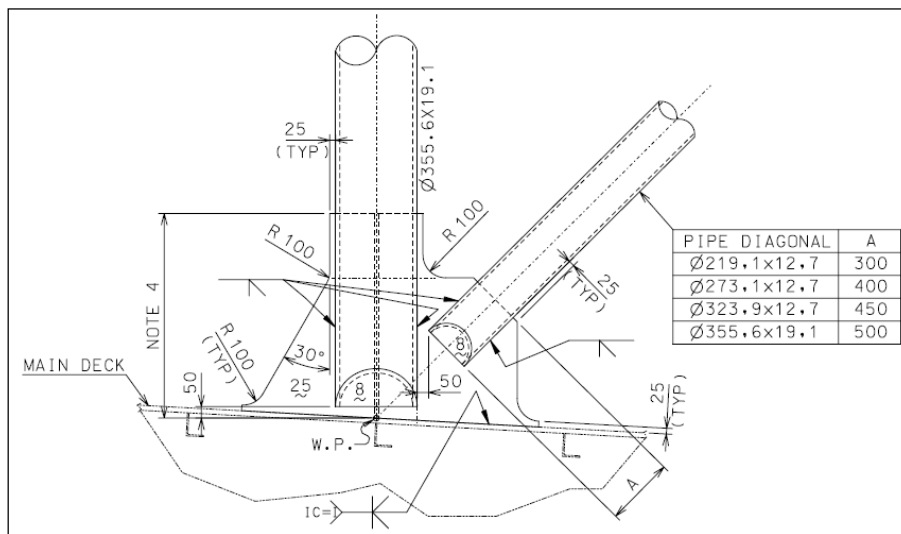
Suporte do módulo – conexão tipo 4 – vista transversal.
